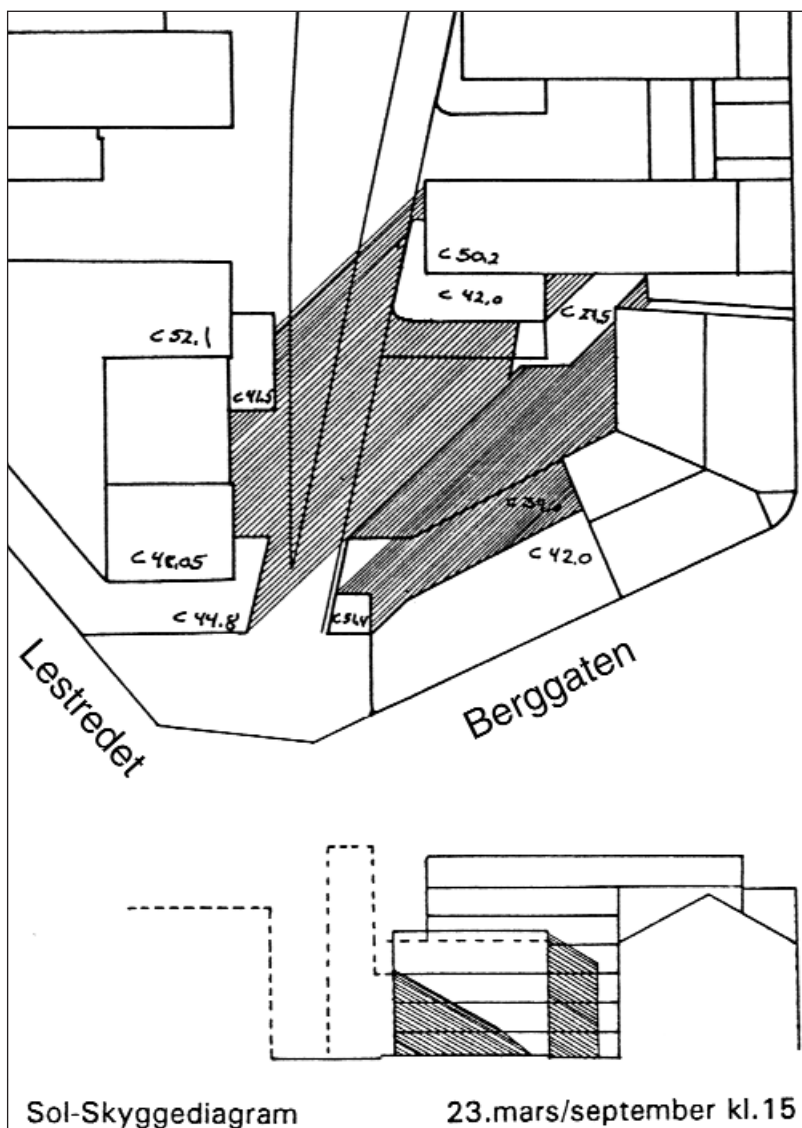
Illustrasjon til utbyggingsplan Eksist. bygg Eksist. mur/fasade Nybygg
